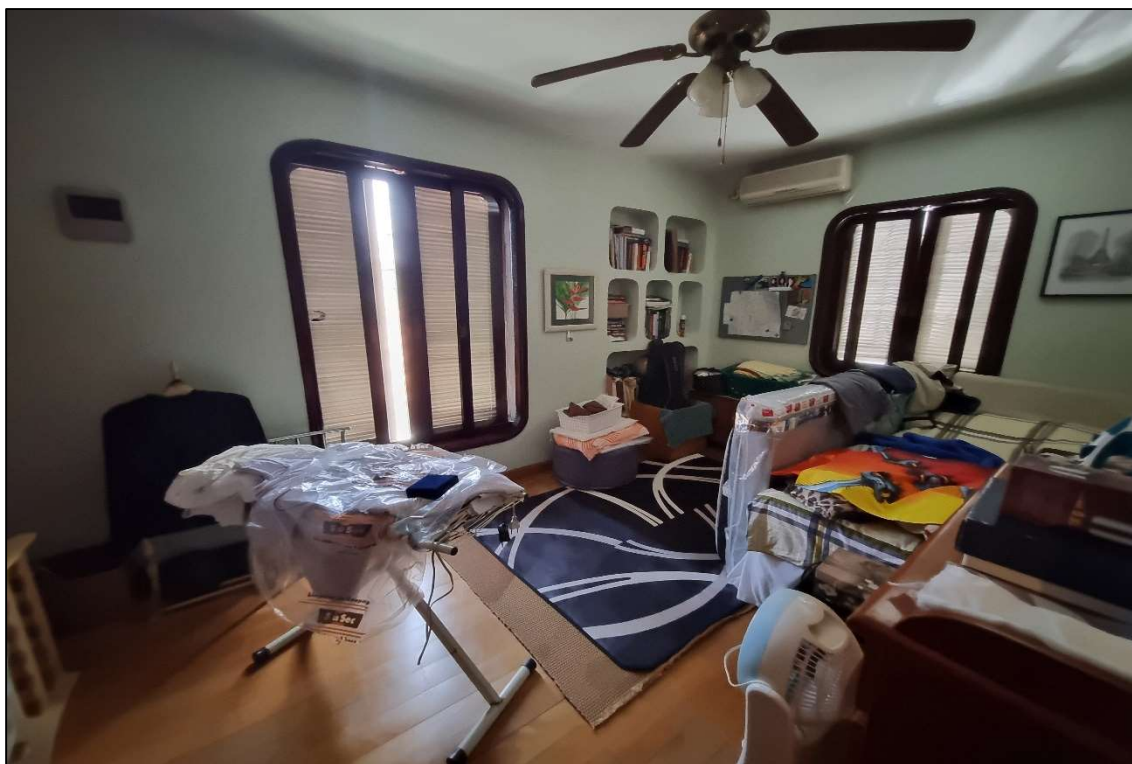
Vista de um dormitório. Suas principais características construtivas são: piso em assoalho de madeira, paredes revestidas em massa corrida pintadas em látex, forro em laje e esquadrias de madeira.
